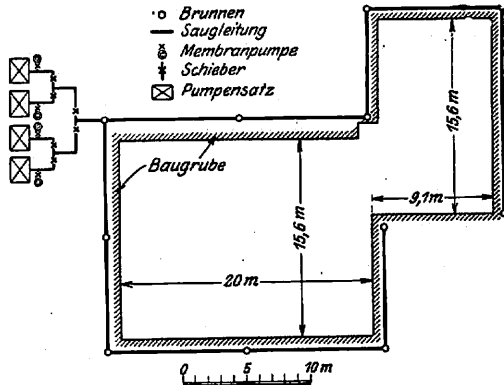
Grundriß der Baugrube des Ammoniakbehälters.
